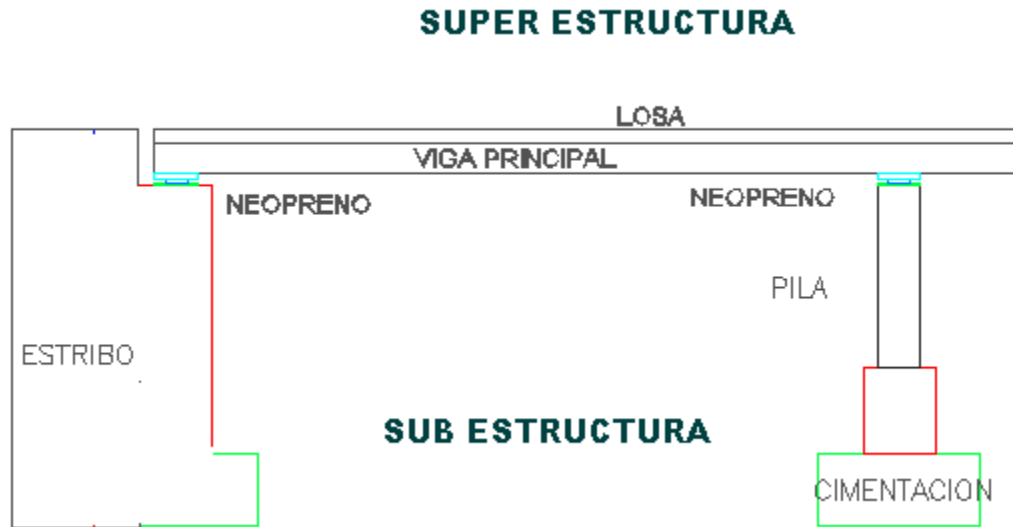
Elementos de la Subestructura y Superestructura de un puente losa
